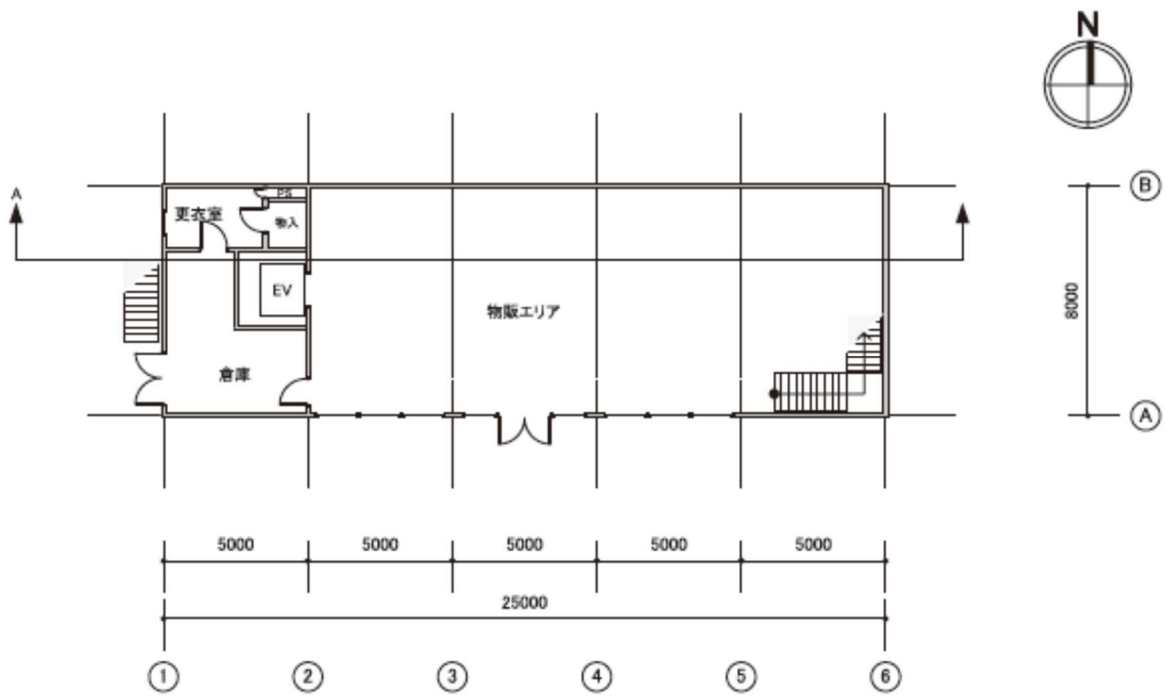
8 モデル建物（小規模物販店舗等） 1階平面図
